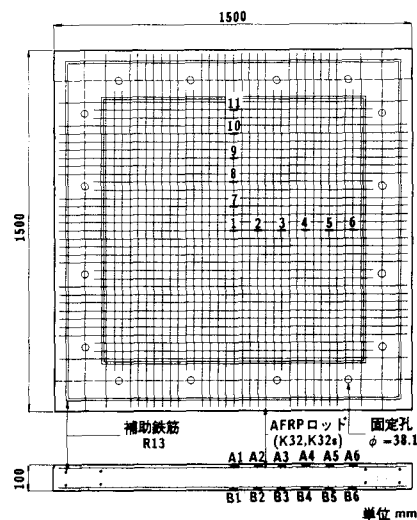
コンクリートスラブの配筋図及びゲージ添付位置図
